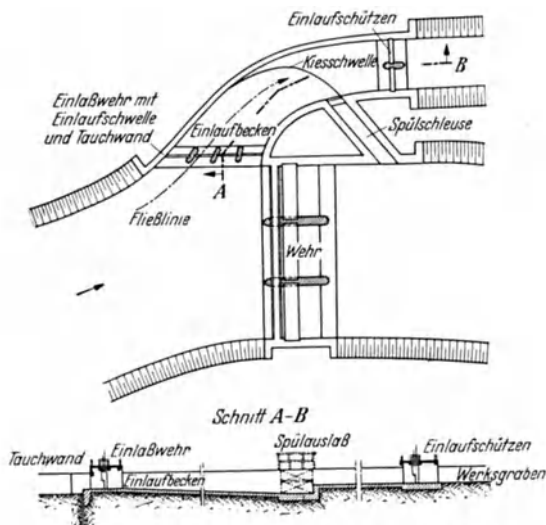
Lageplan und Schnitt einer Triebwasserfassung.
